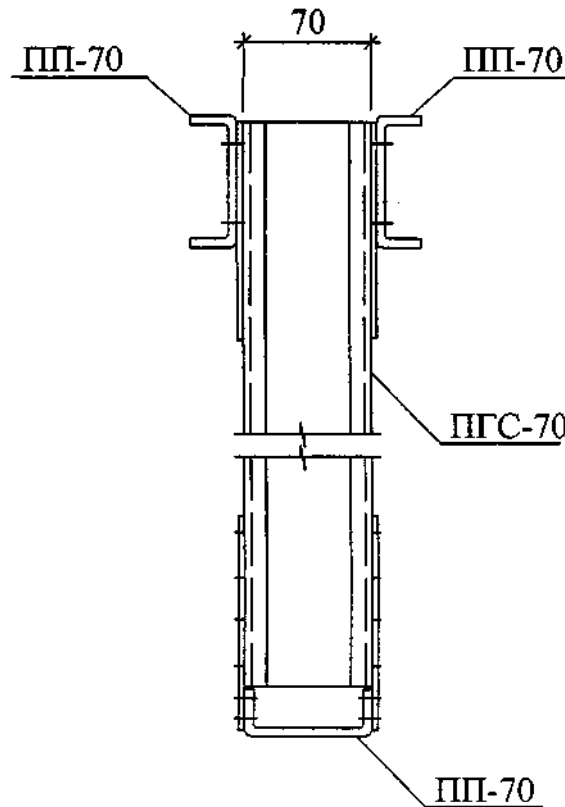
Переріз ферми з верхнім поясом з двох профілів
